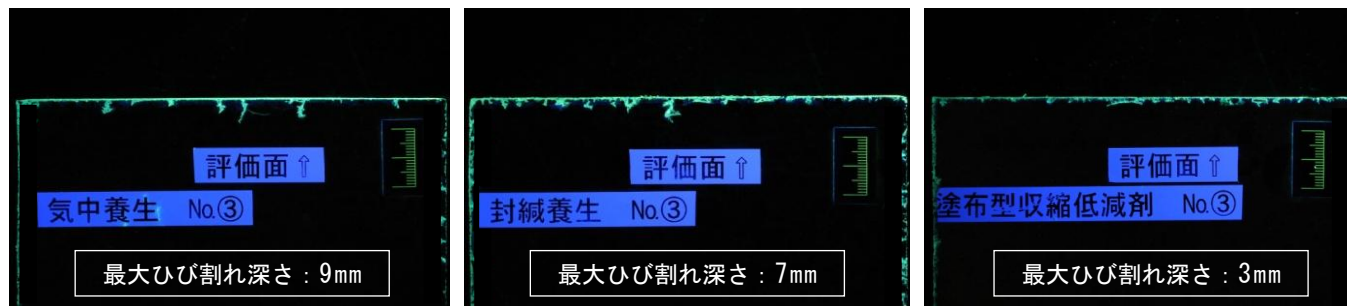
蛍光エポキシ含浸によるひび割れ観察写真
